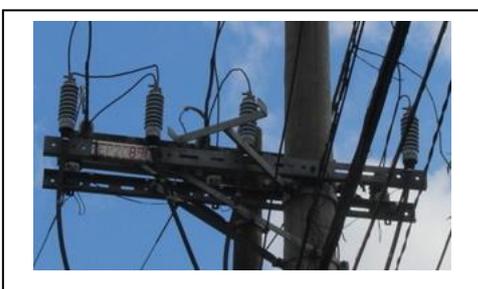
ISOLADORES APARENTEMENTE EM BOAS CONDIÇÕES INSTALAÇÃO
